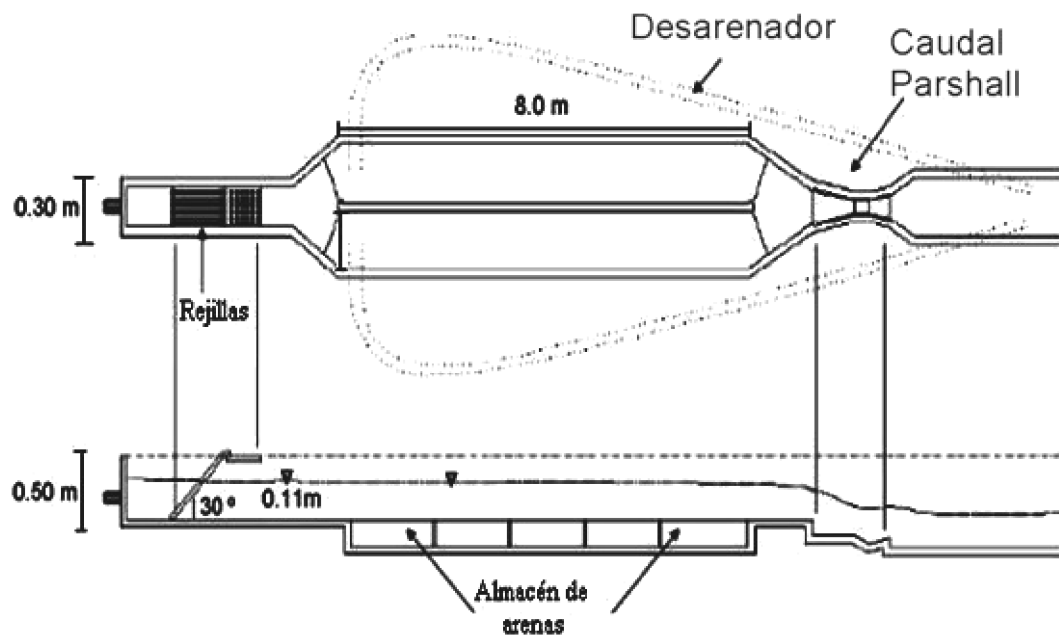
Esquema de rejillas y desarenador de la Planta N°1
